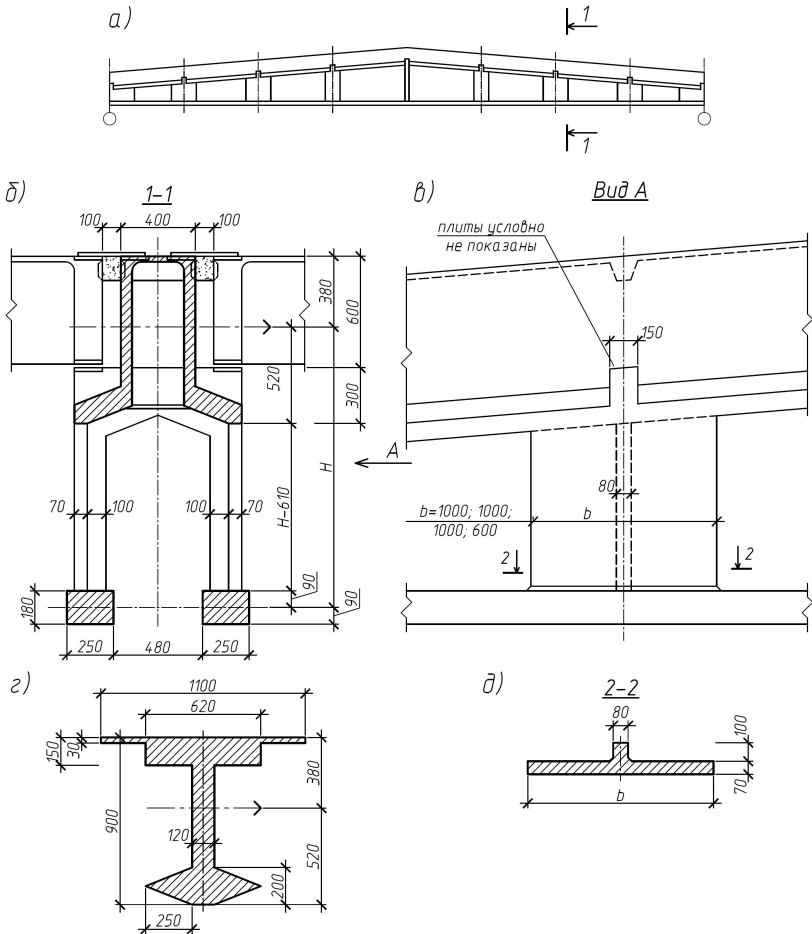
Сборно-монолитная стропильная конструкция, где: а) - общий вид; б) - поперечное сечение сборной части; в) - вид сбоку; г) - расчетное сечение верхнего пояса; д) - сечение стойки
